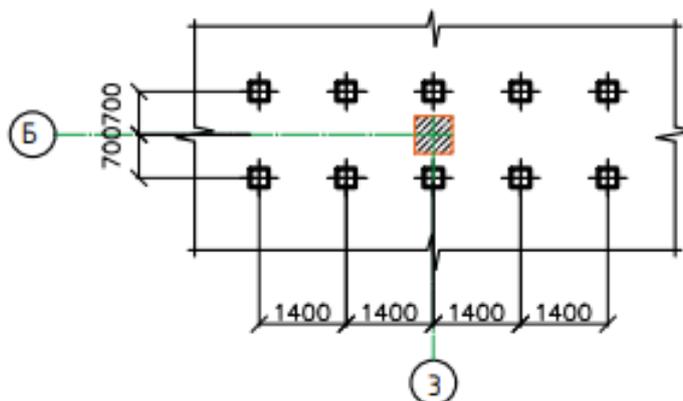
Схема расположения свай под фрагмент плитного фундамента
